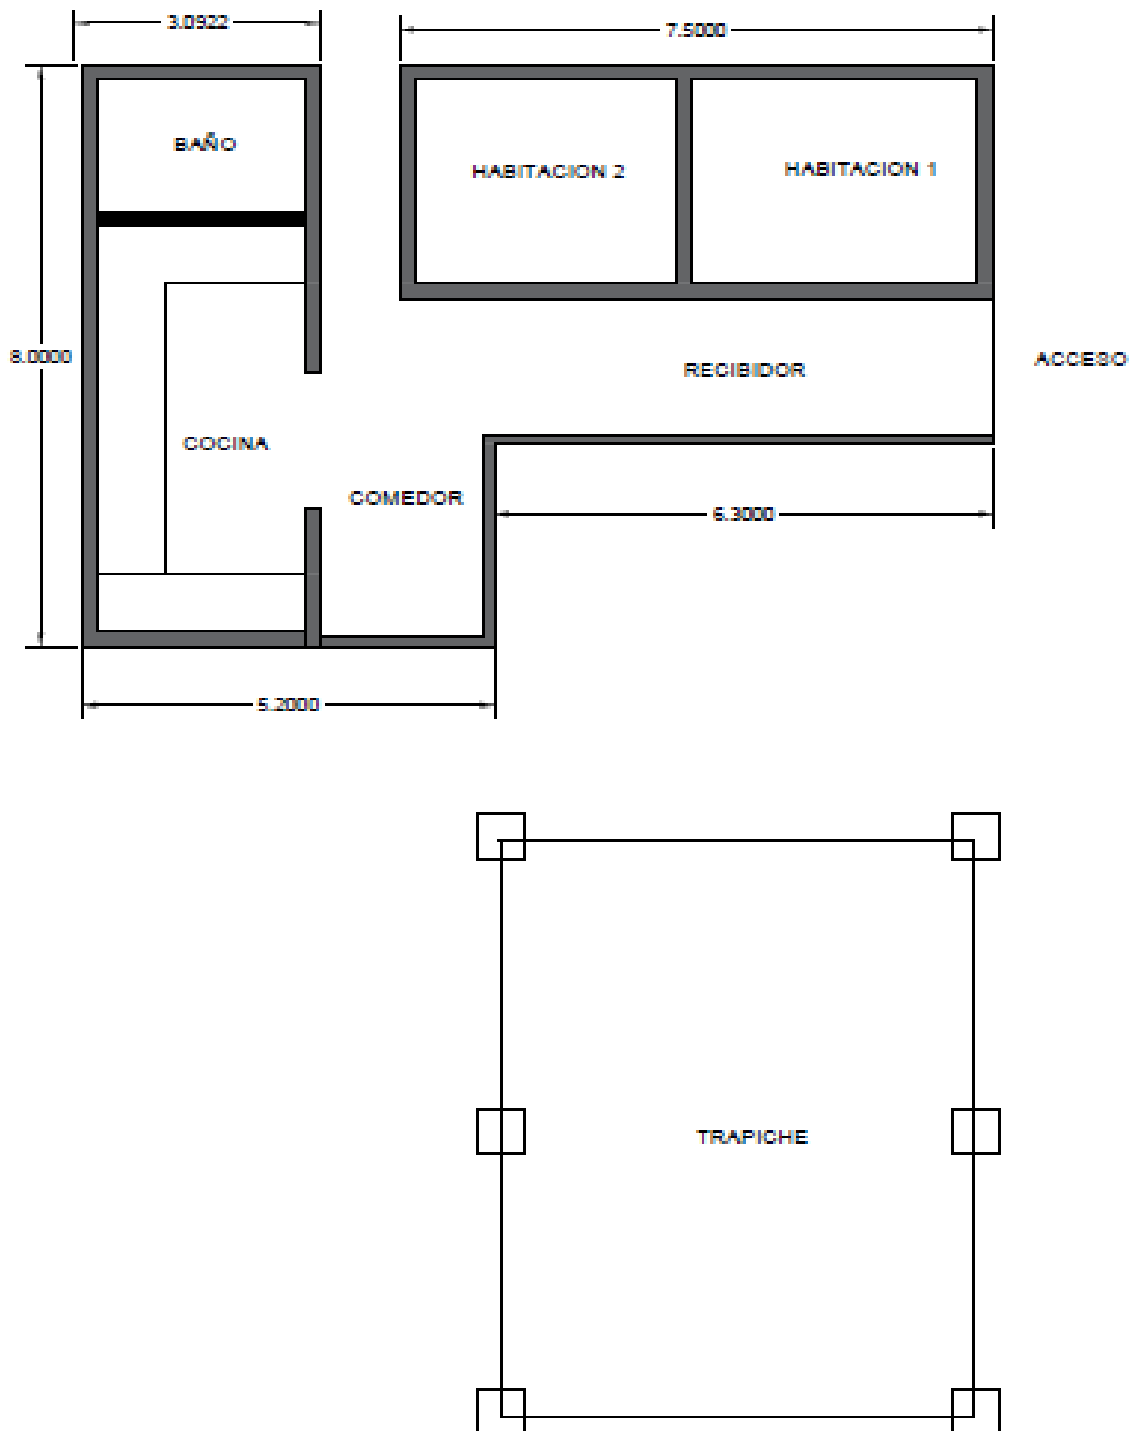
Plano vivienda vereda #2. Fuente propia
